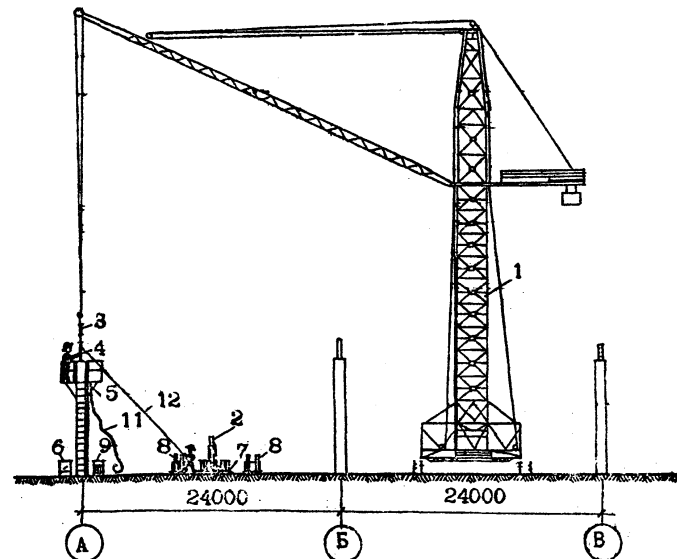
Схема организации рабочего места при монтаже подстропильных ферм.
